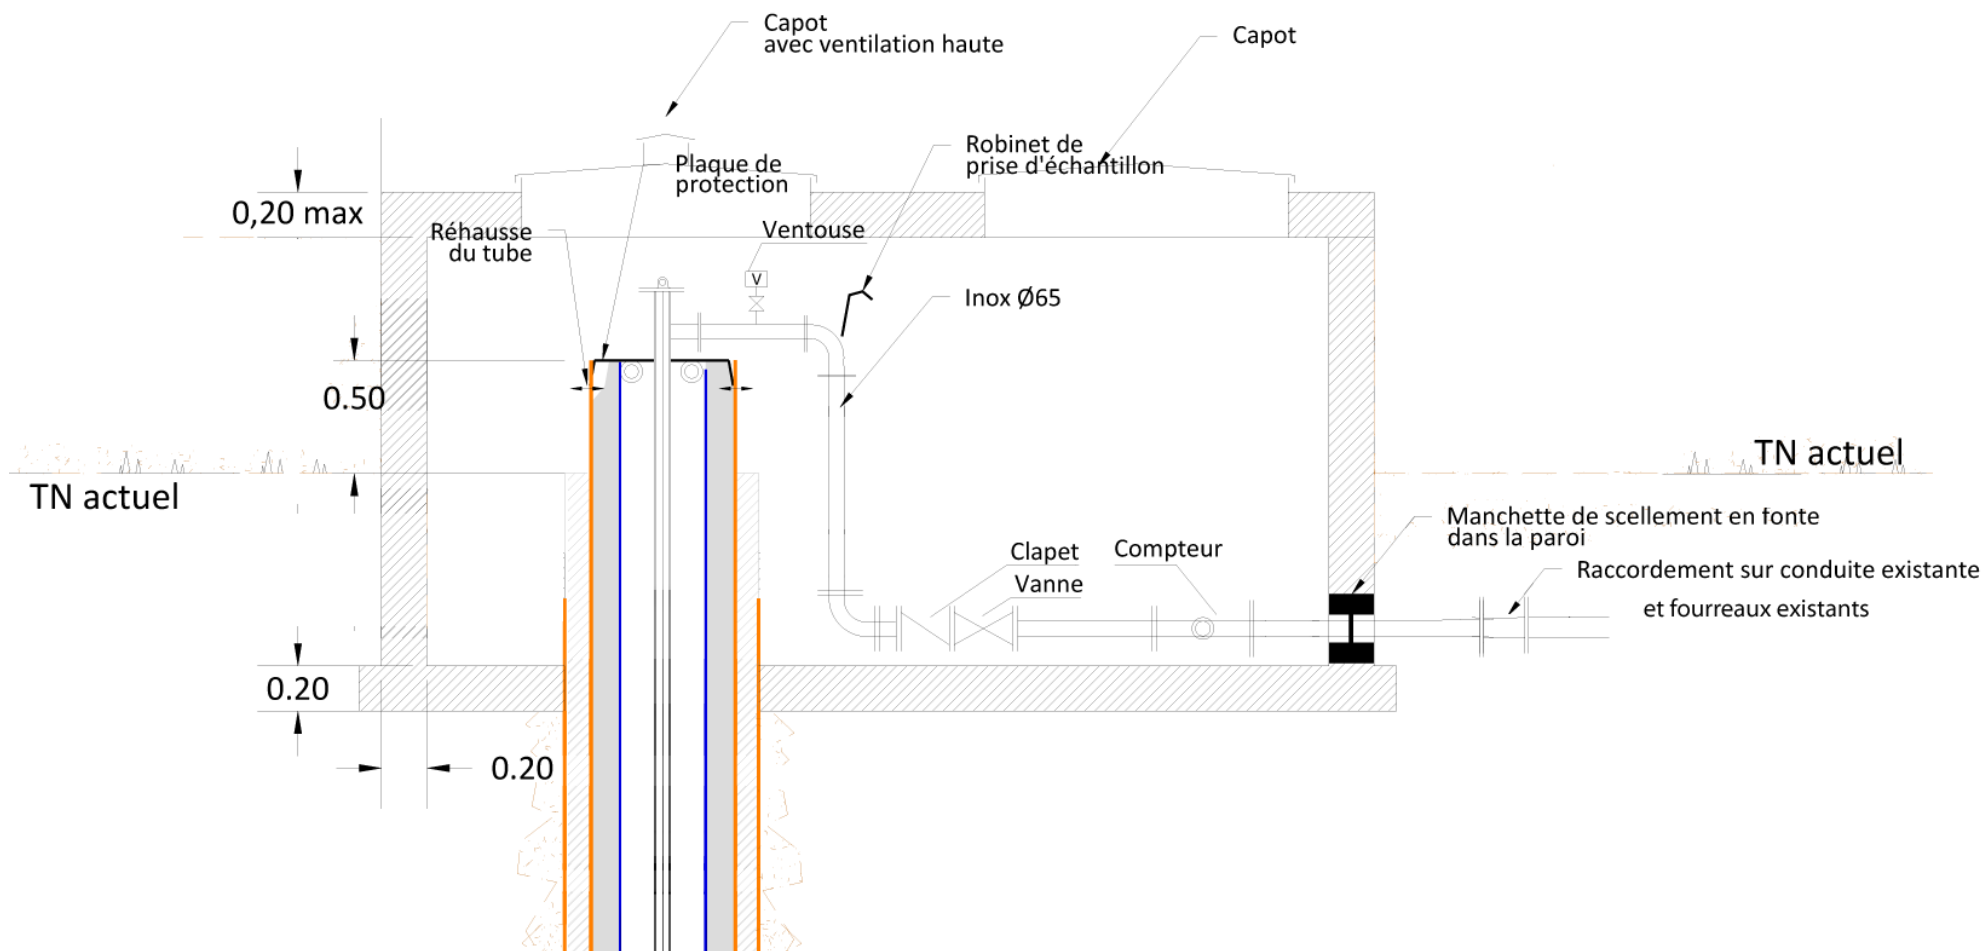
Plan guide de la tête de puits du forage F3 projeté
